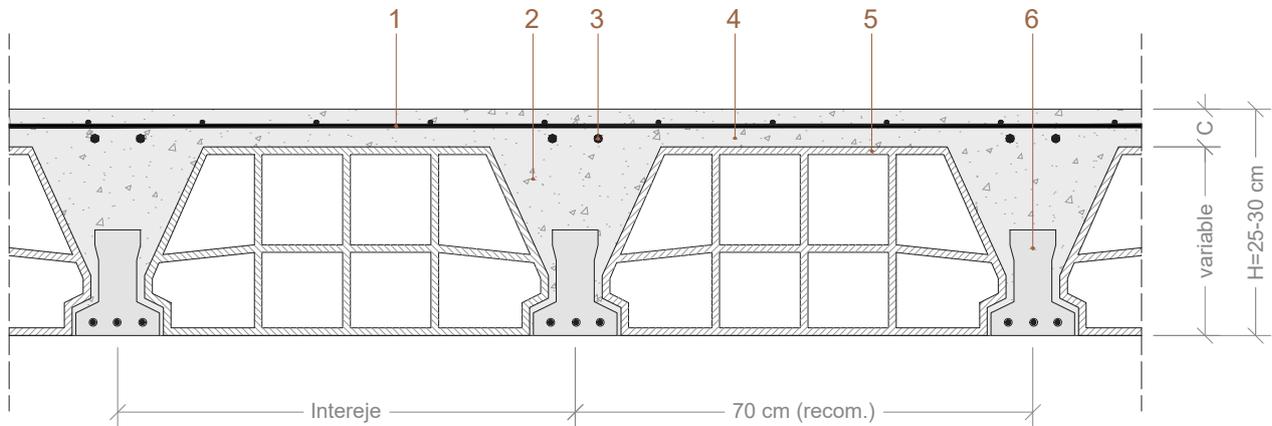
Sección tipo de forjado con viguetas semirresistentes
